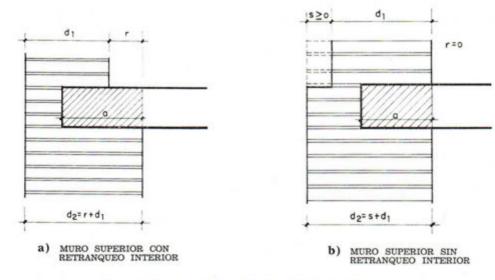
APOYO DE FORJADOS SOBRE MUROS
